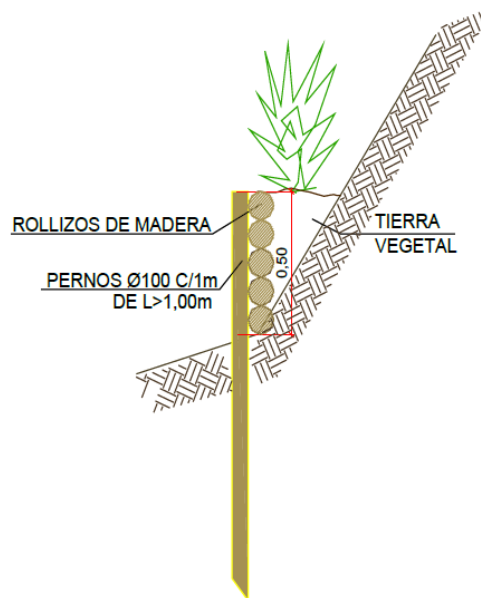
Vista lateral de fajina mixta revegetada. Fuente: Elaboración propia.
